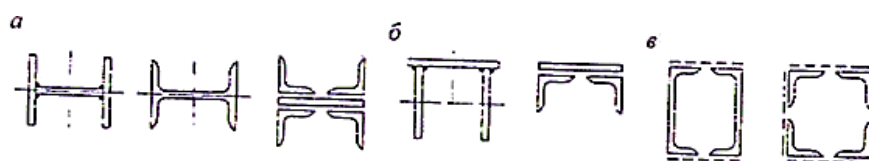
Сечение элементов тяжелых ферм:
